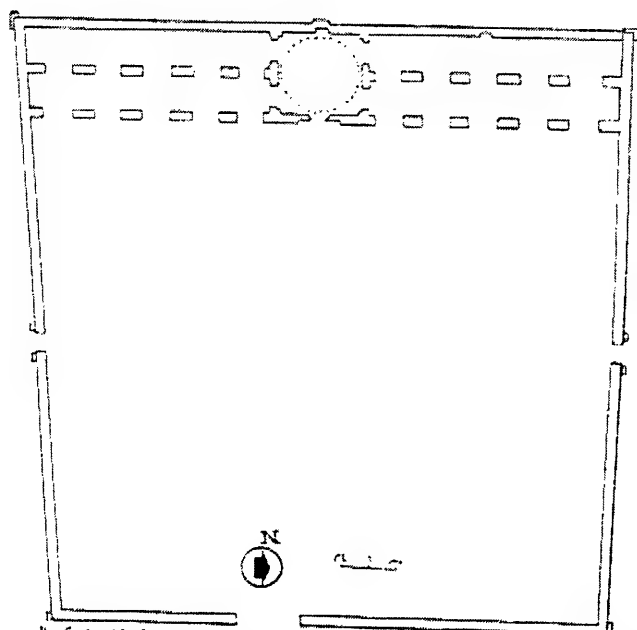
المسقط الأفقي لجامع أحمد بن طولون بالقاهرة (٢٦٣-٢٦٥هـ /
